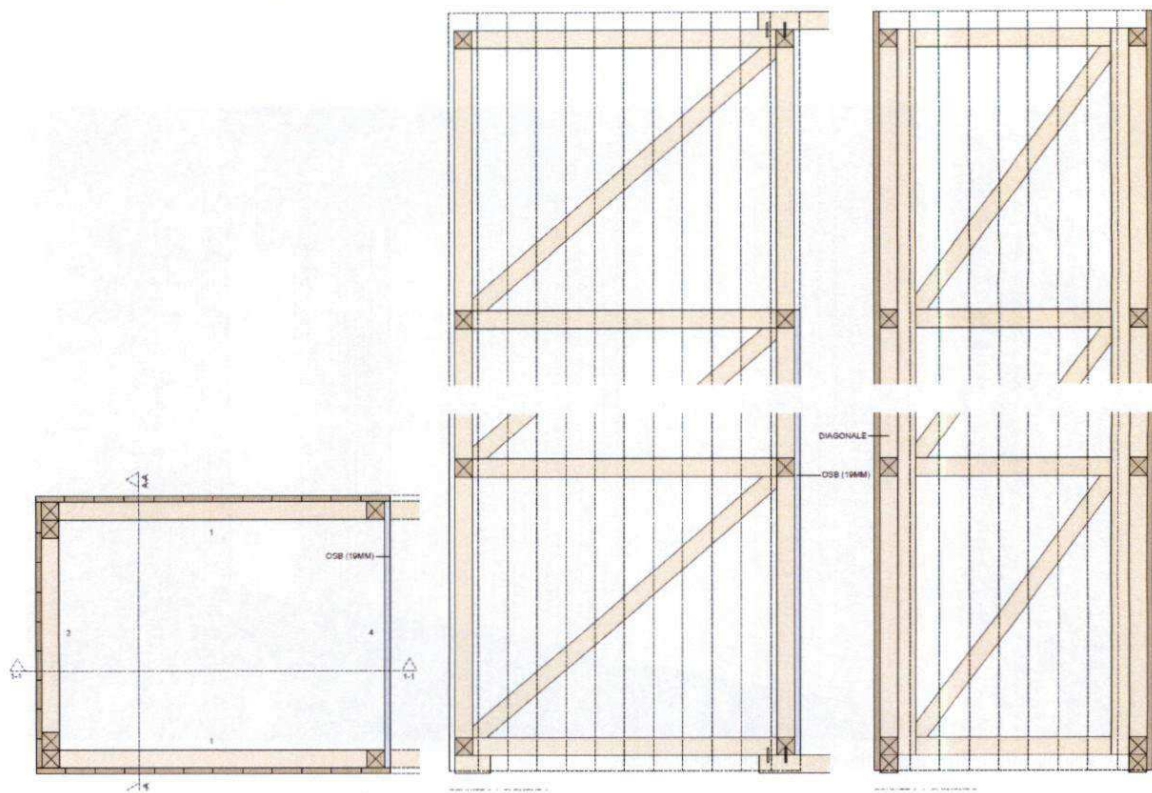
Detail Ansicht + Grundriss Stellwand
